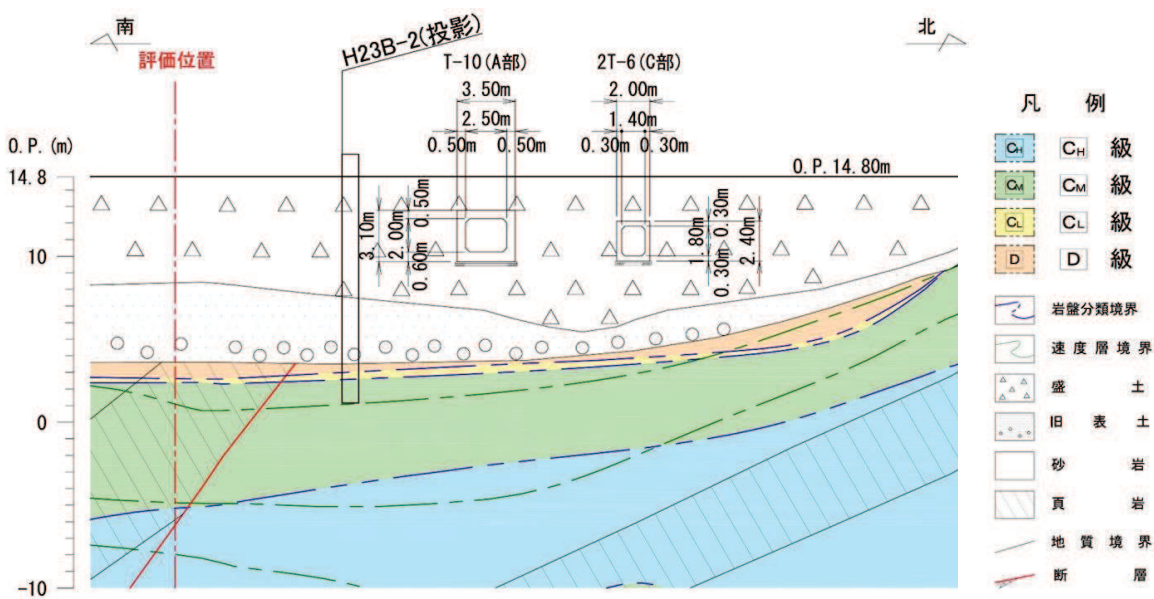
地質断面図 (C-C' 断面) 及びボーリング調査の代表位置
